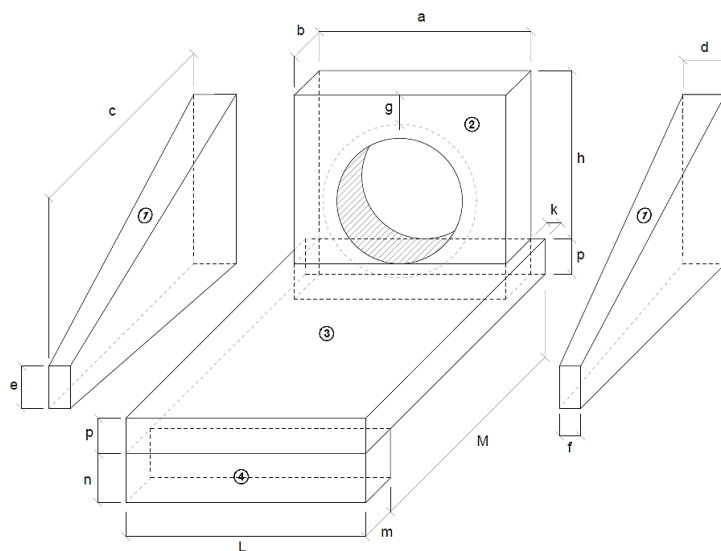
Detalhamento das dimensões da boca de bueiro simples com alas retas -
